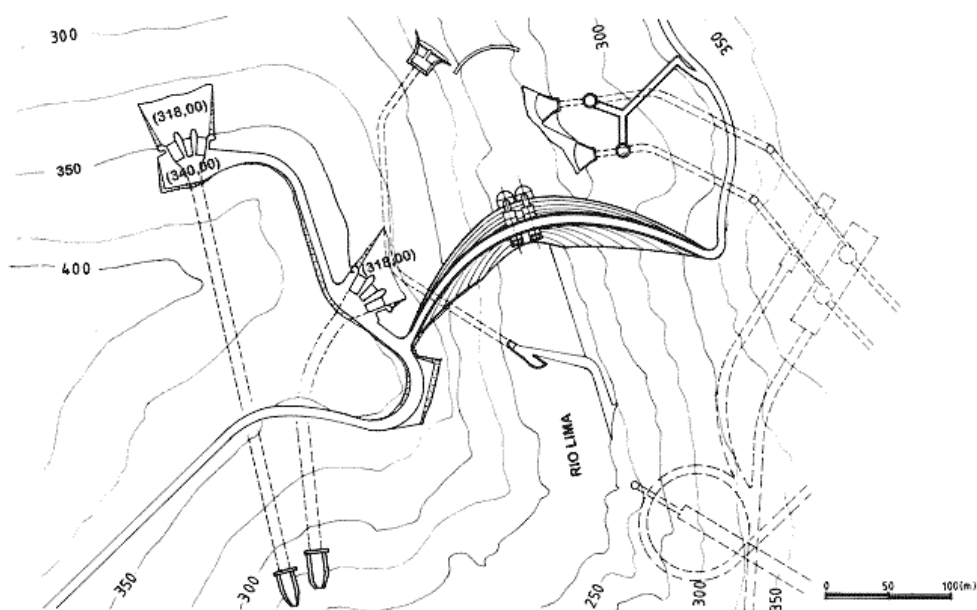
Barragem do Alto Lindoso. Planta (fonte: www.inag.pt)
